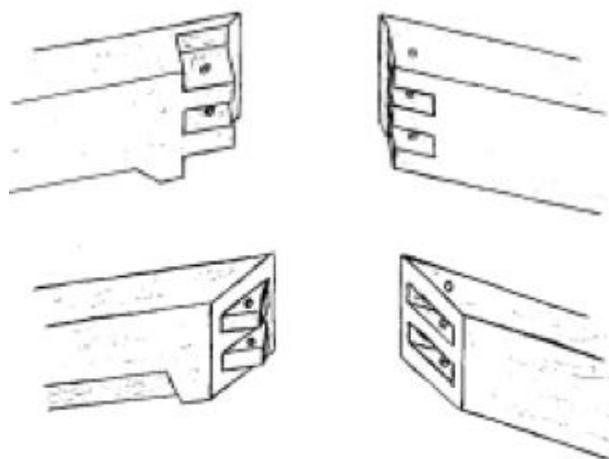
Deux exemples d'assemblage particulièrement soignés à deux tenons et mortaises
